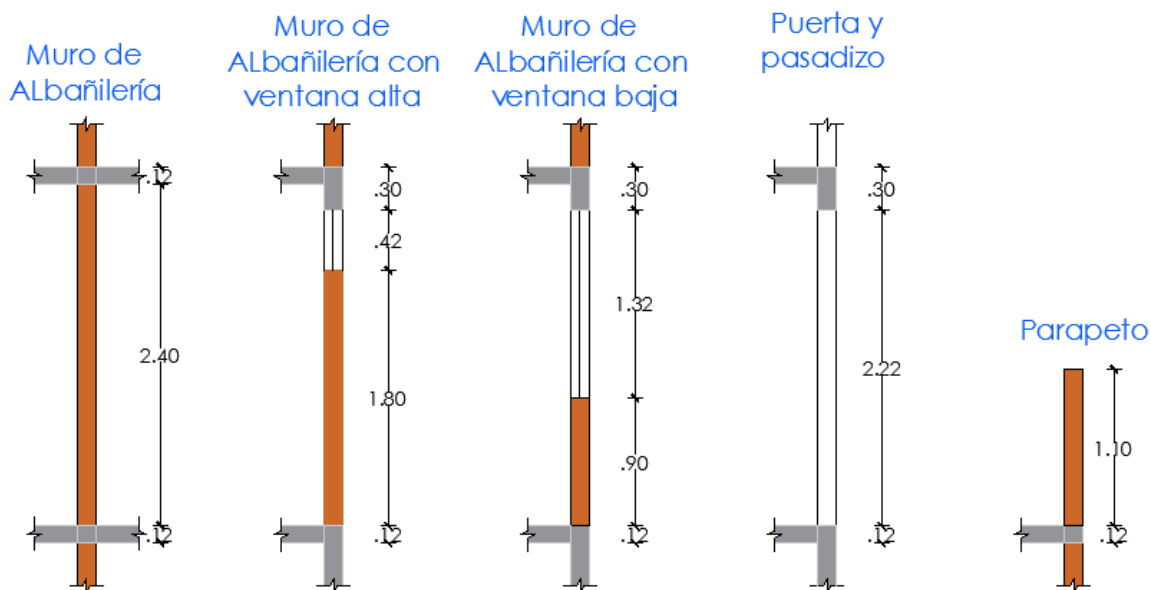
Secciones verticales típicas. Fuente: Elaboración propia.
